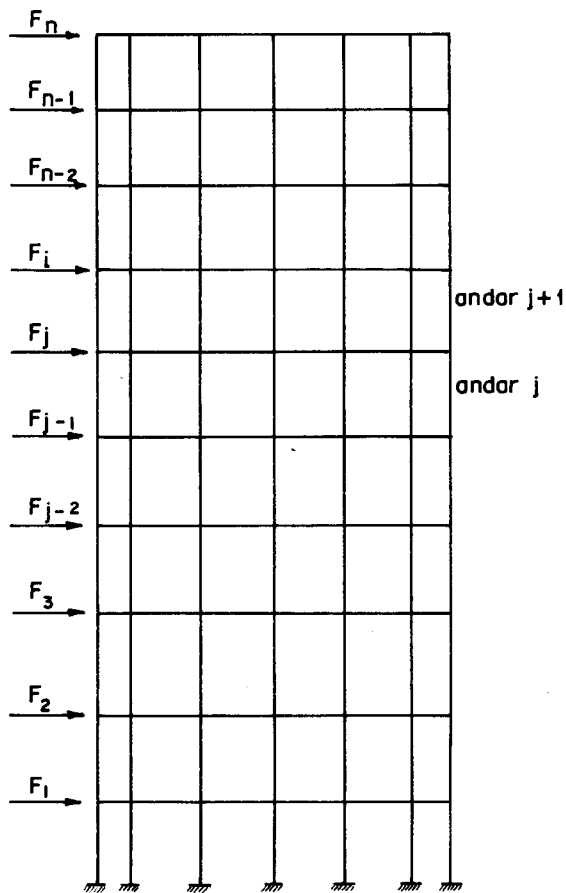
CARGAS EXTERNAS NO EDIFÍCIO, PROVOCANDO APARECIMENTO DE M NAS VIGAS E PILARES.
